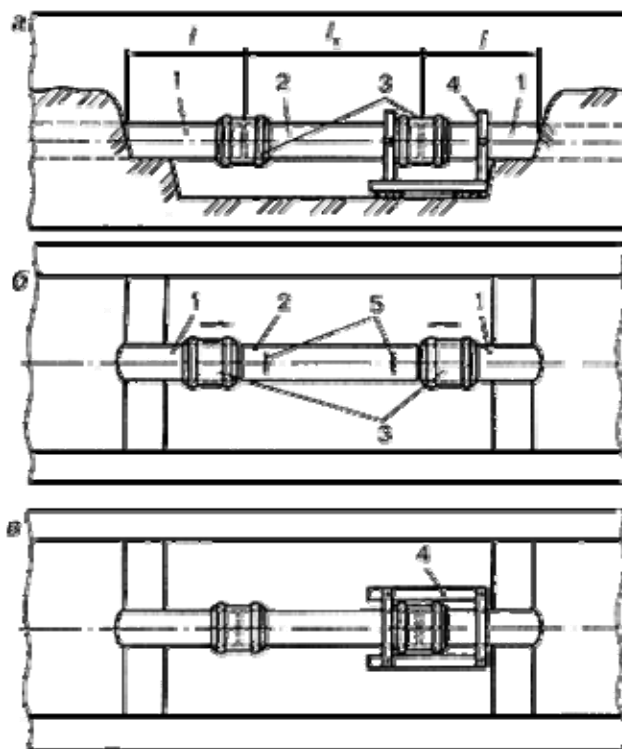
Схемы освобождения полиэтиленового трубопровода от грунтовой присыпки (а) и последовательности сварки трубной вставки с применением муфт с закладными нагревателями (б, в)
